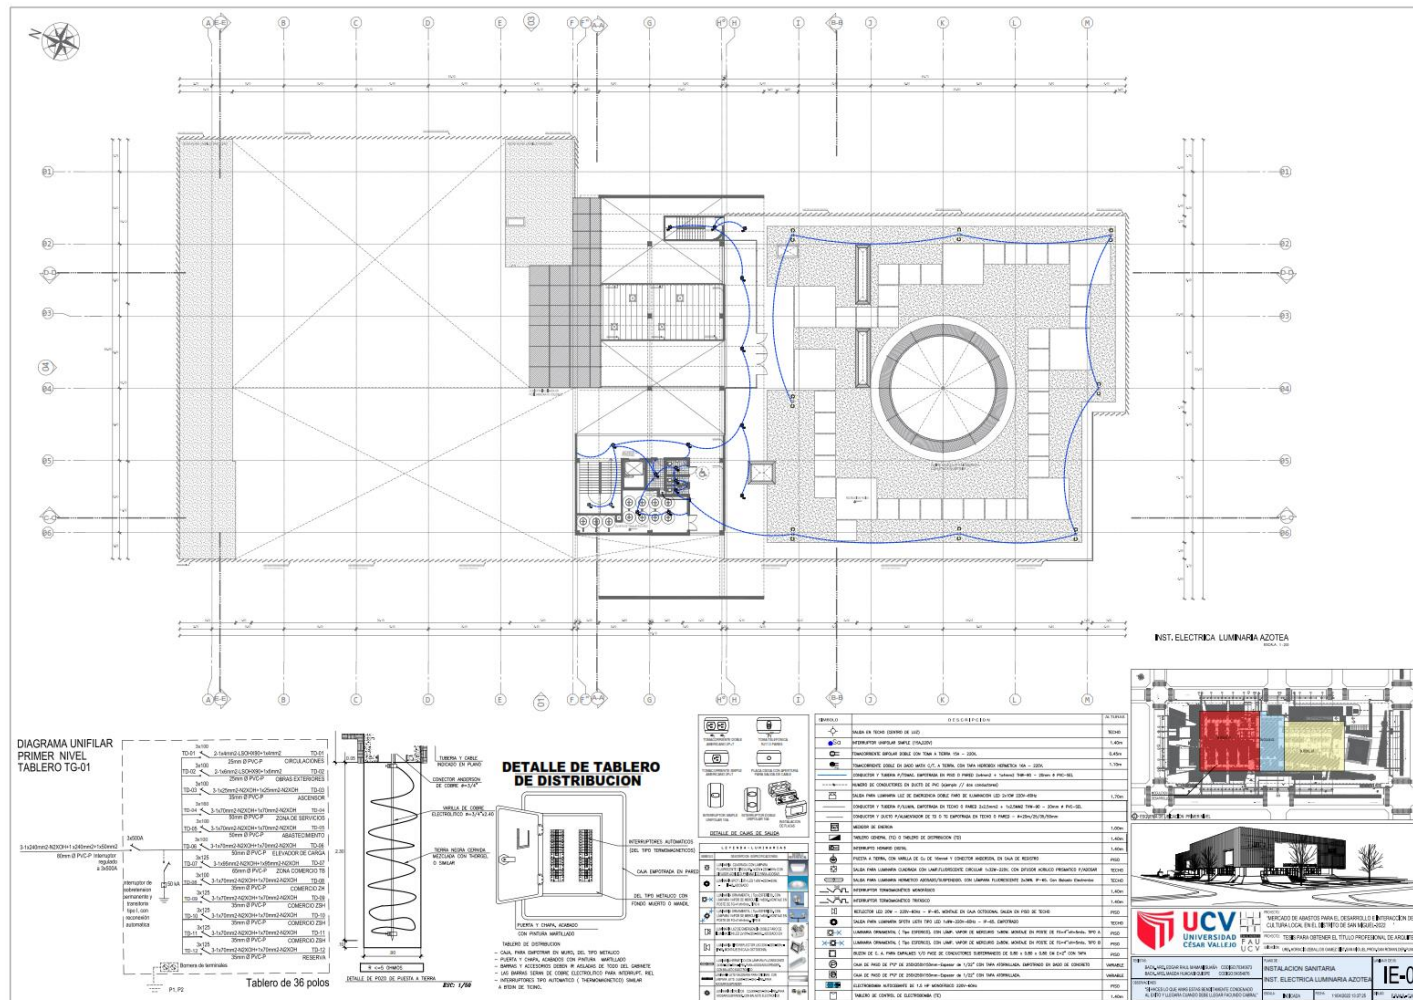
Plano de distribución de red de instalación eléctrica alumbrado tercer nivel.
